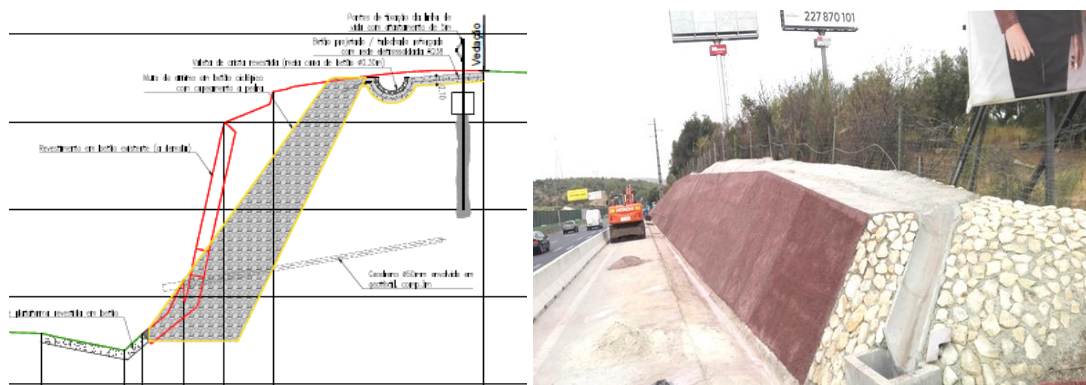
Perfil transversal tipo da solução de projeto e aspeto final da solução do muro de arrimo
